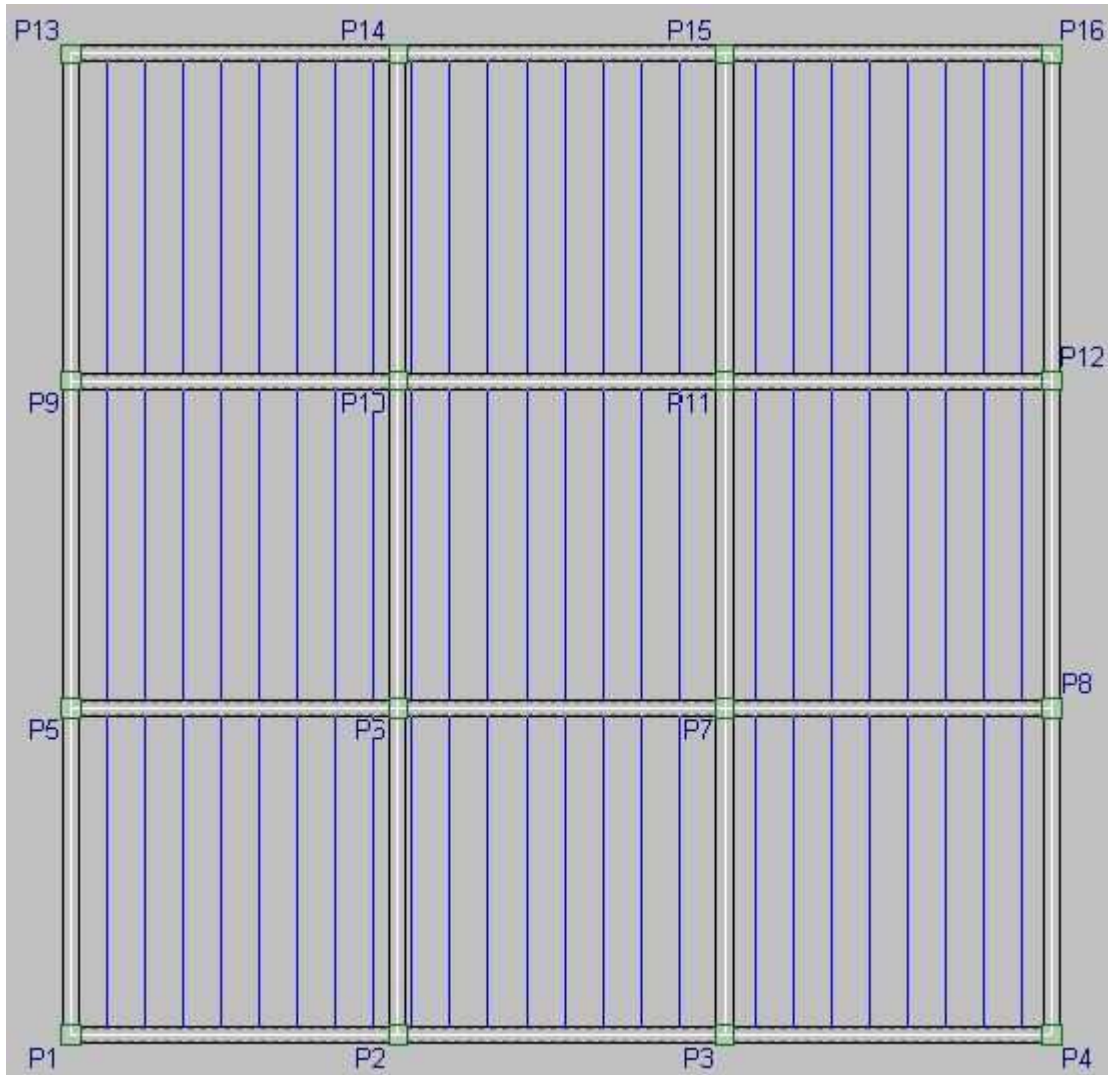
Vista en planta. Planta tipo previa al cálculo.
